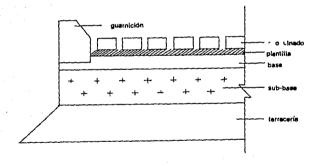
Sección típica de un pavimento de adoquín de concreto
